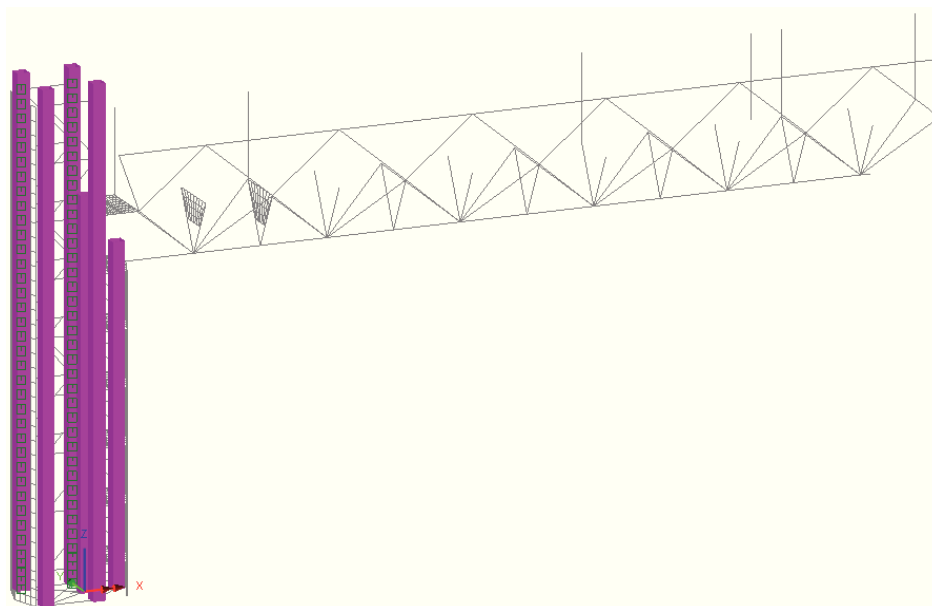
Dettaglio della traversa – Prospetto laterale
